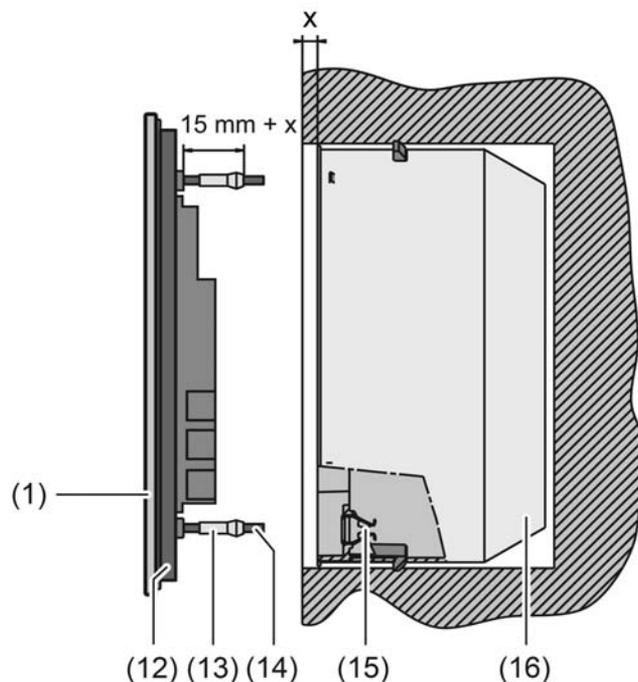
Gerätemontage eines Glas-Sensors TS Komfort
